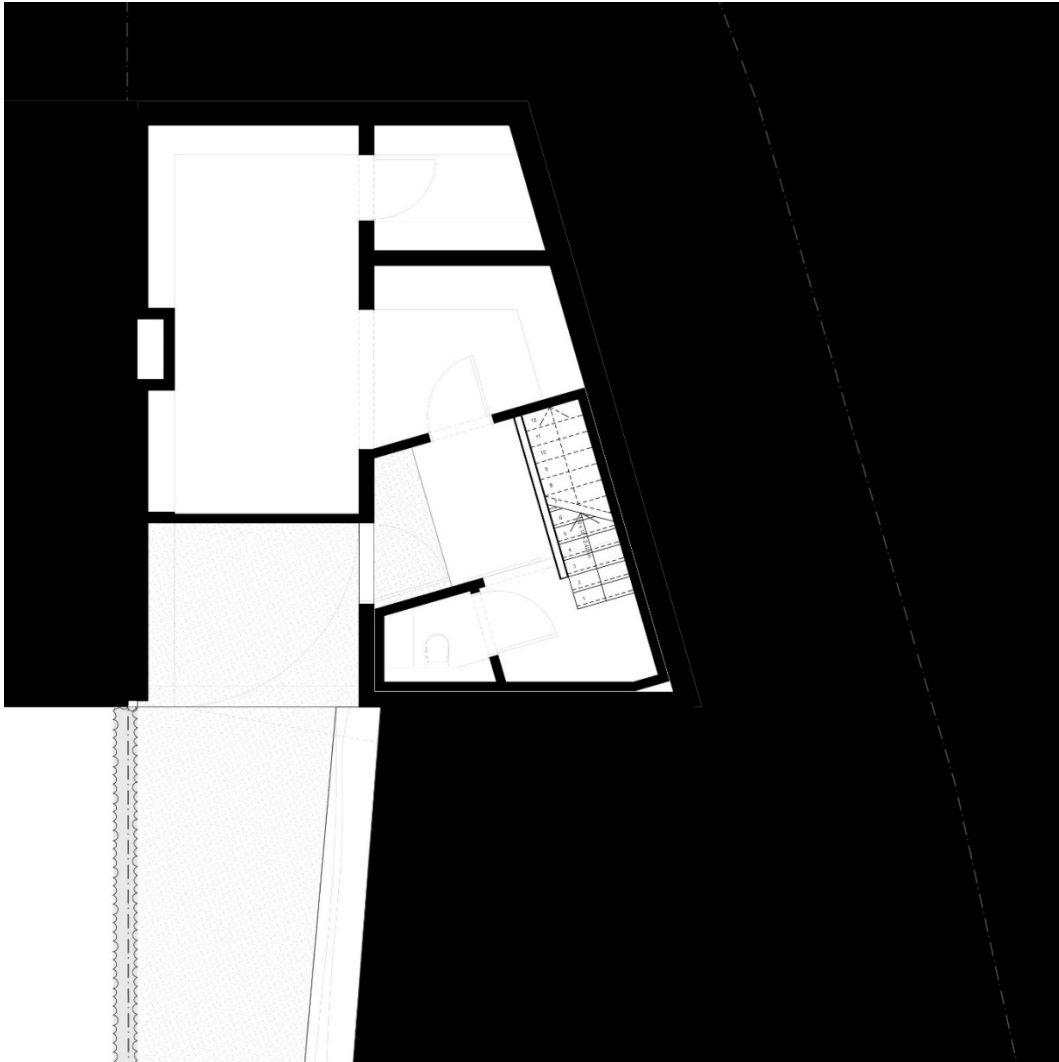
Plan rez-de-chaussée (Karbon'architecture et urbanisme)
